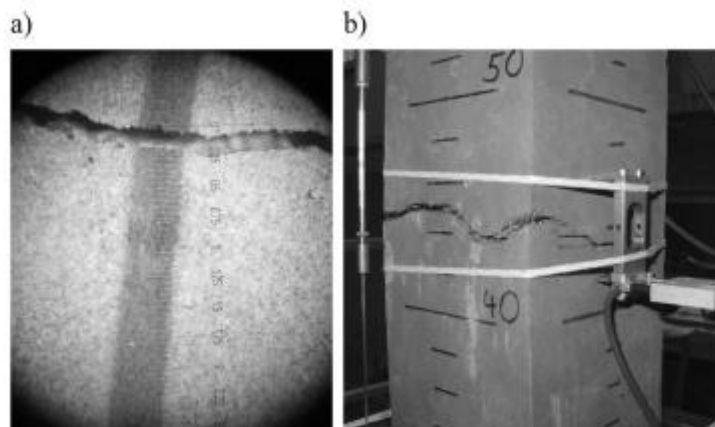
Pruebas de tensión: a) detalle de la fisura cuando el acero de refuerzo en su límite de fluencia, b) detalle de la fisura a la carga máxima.
